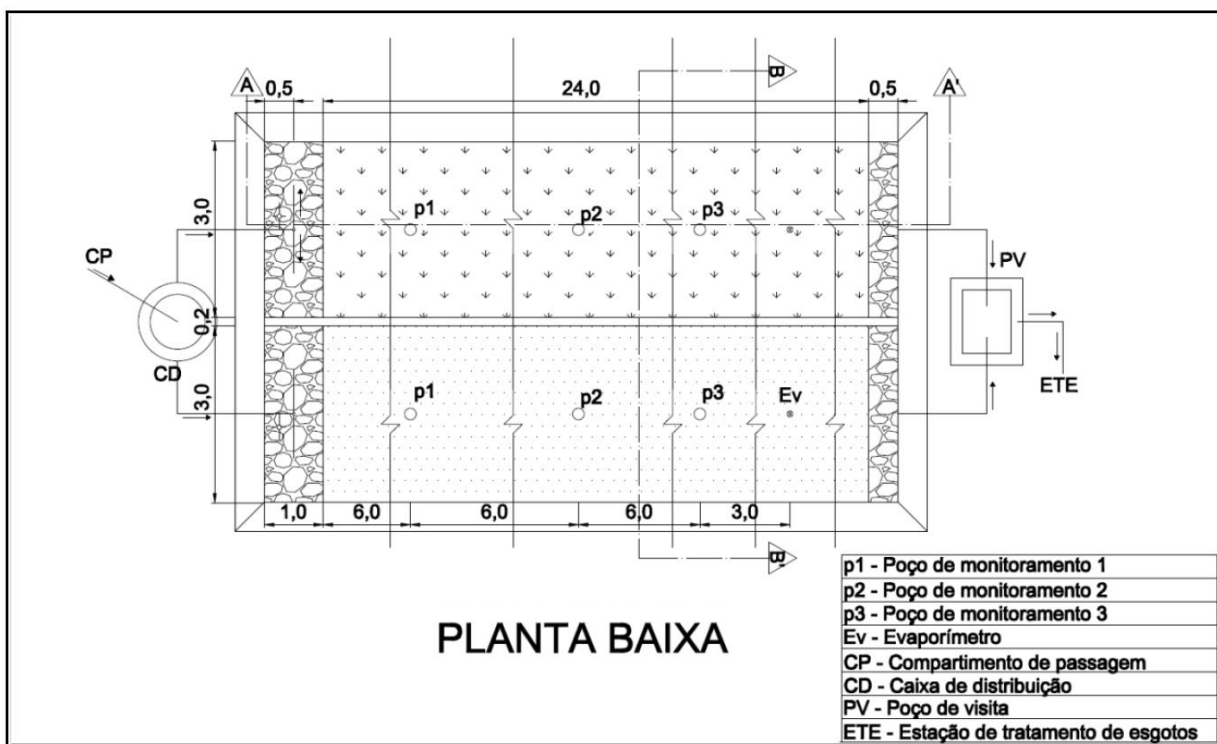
Planta baixa dos wetlands com detalhes construtivos. Fonte: Matos (2015).
